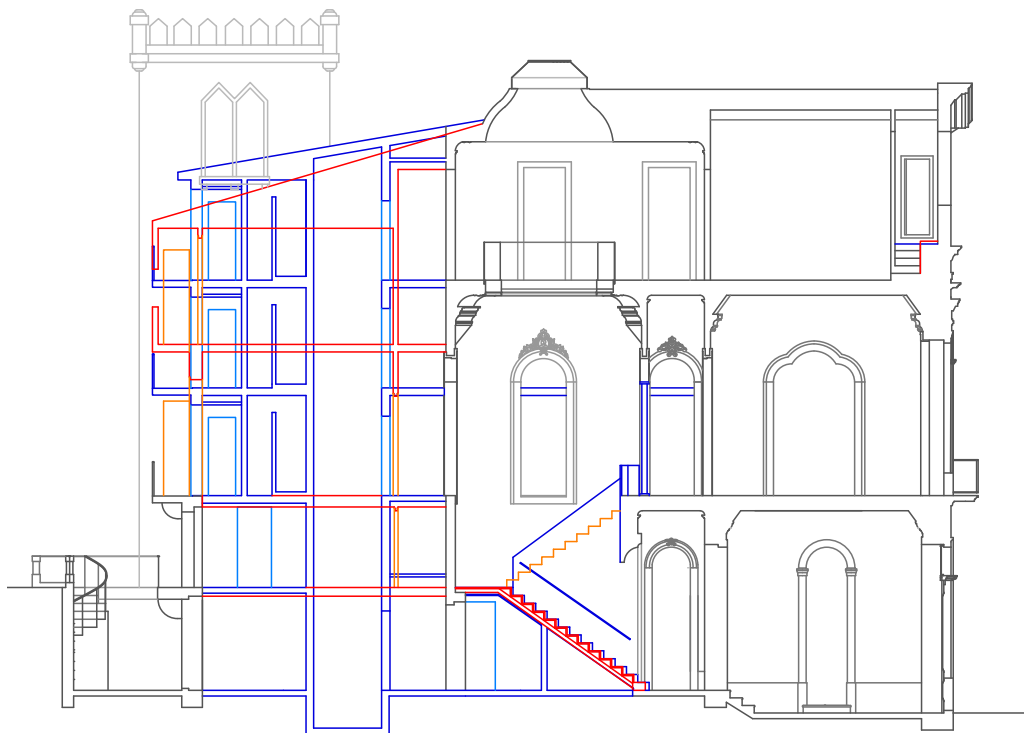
Demolições e novas construções - Corte central - escala 1:200
